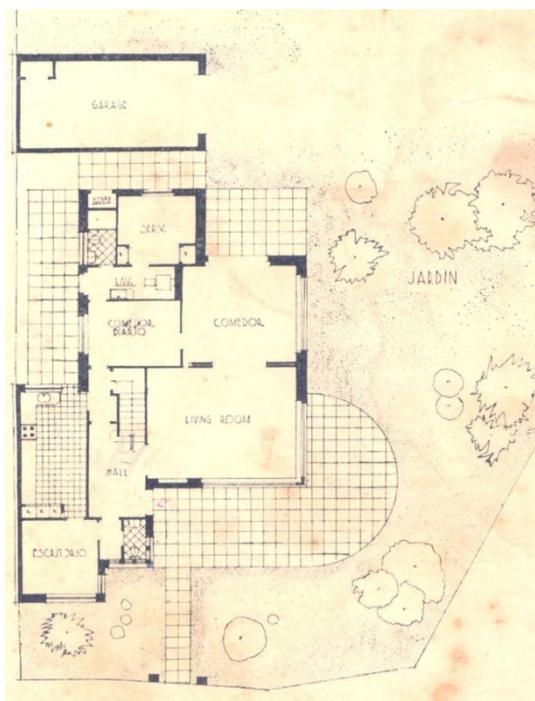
Edificação existente na Argentina, construída pelo arquiteto Carlos Vilar.
